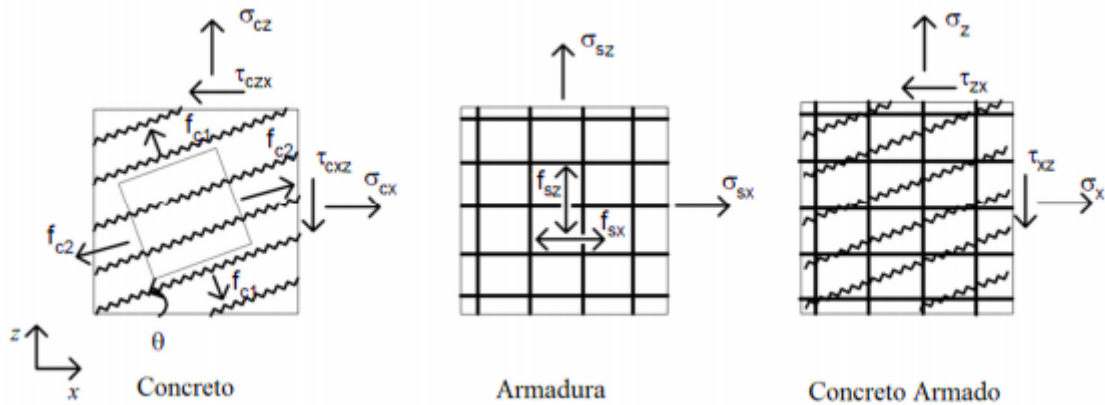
Tensões nos painéis de concreto, armadura e concreto armado, BENTZ et al. (2006).
